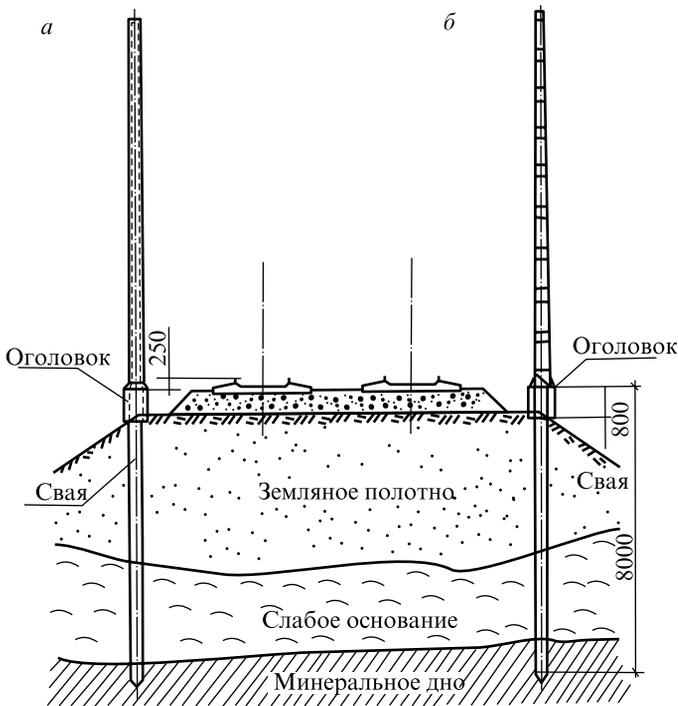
Установка опор контактной сети ССА (а) и МК (б) на свайном фундаменте (общий вид)
